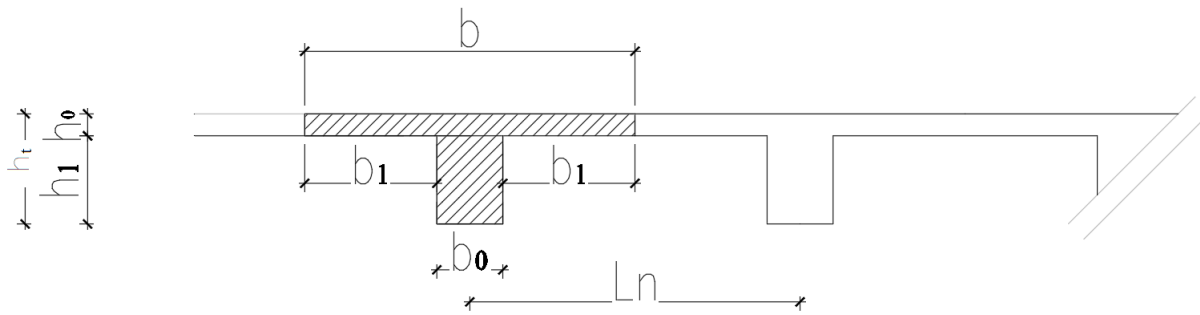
schéma de calcul d'un plancher a corps creux.
